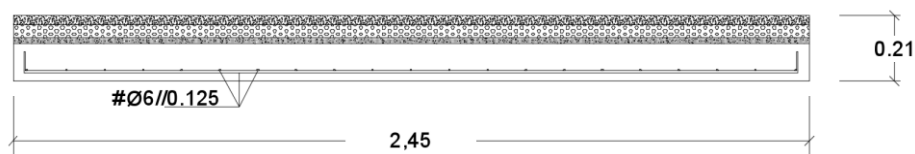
Laje reforçada com UHPFRC, LWAC e RuC
